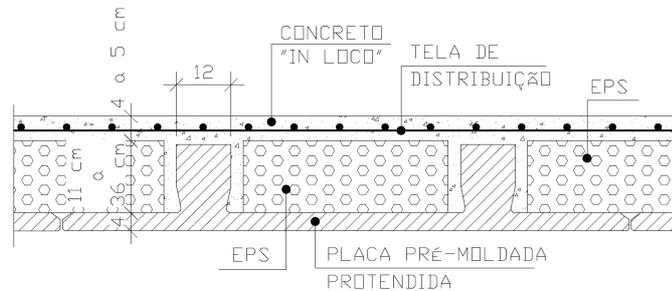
Detalhe da Seção transversal do pavimento utilizando Pré-laje.
